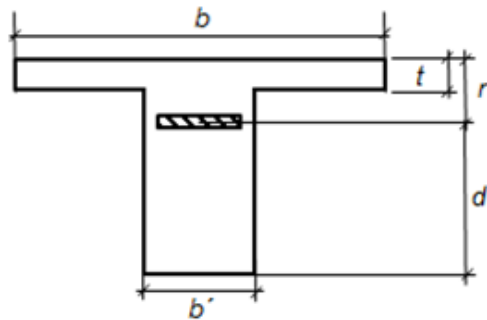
Viga "T" (contribución del acero a tensión de la losa)
